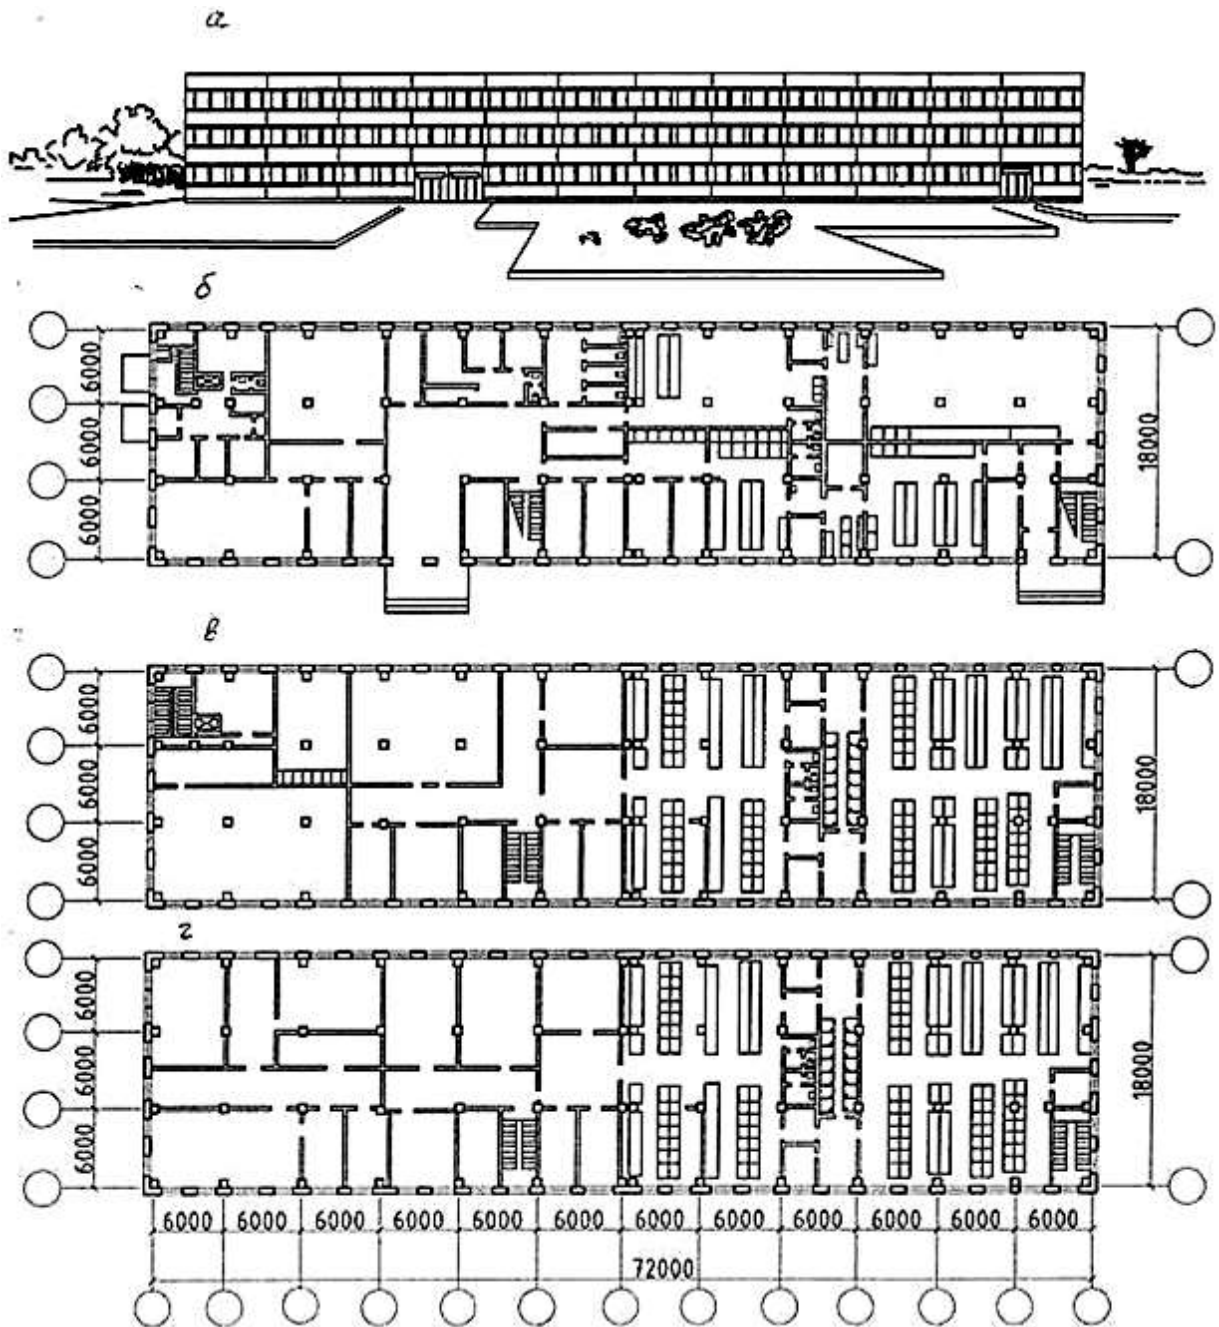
Об'ємно-планувальні рішення окремо розташованої триповерхової каркасно-панельної адміністративно-побутової будівлі: а – фасад; б – план першого поверху; в – план другого поверху; г – план третього поверху
